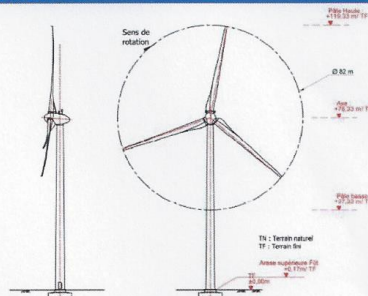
Plan d'élevation de l'éolienne ENERCON E82
